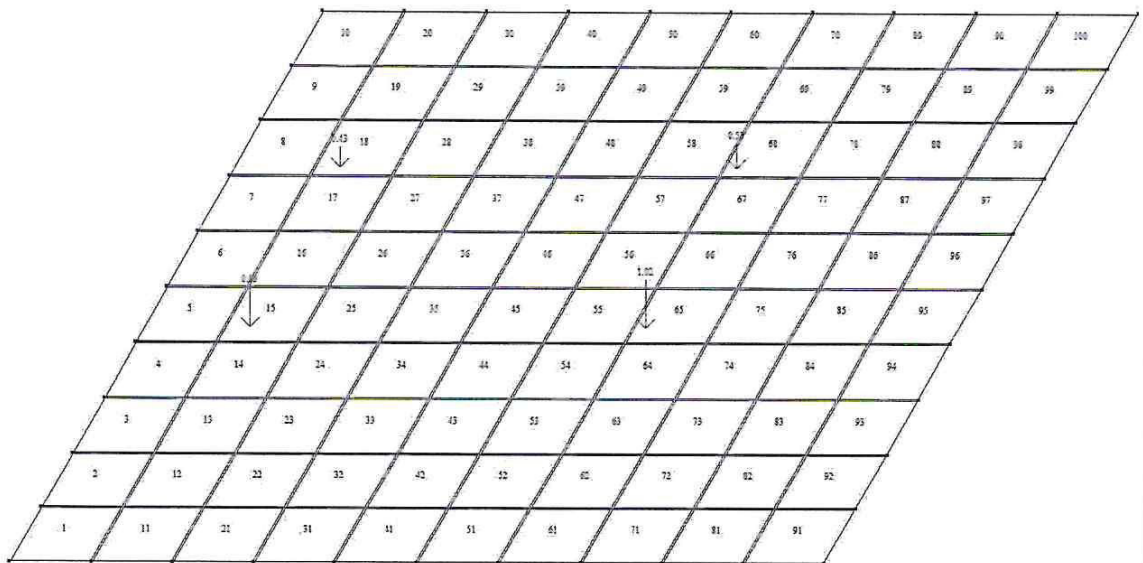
Нагрузки на плиту перекрытия шахты от лифтового оборудования.
